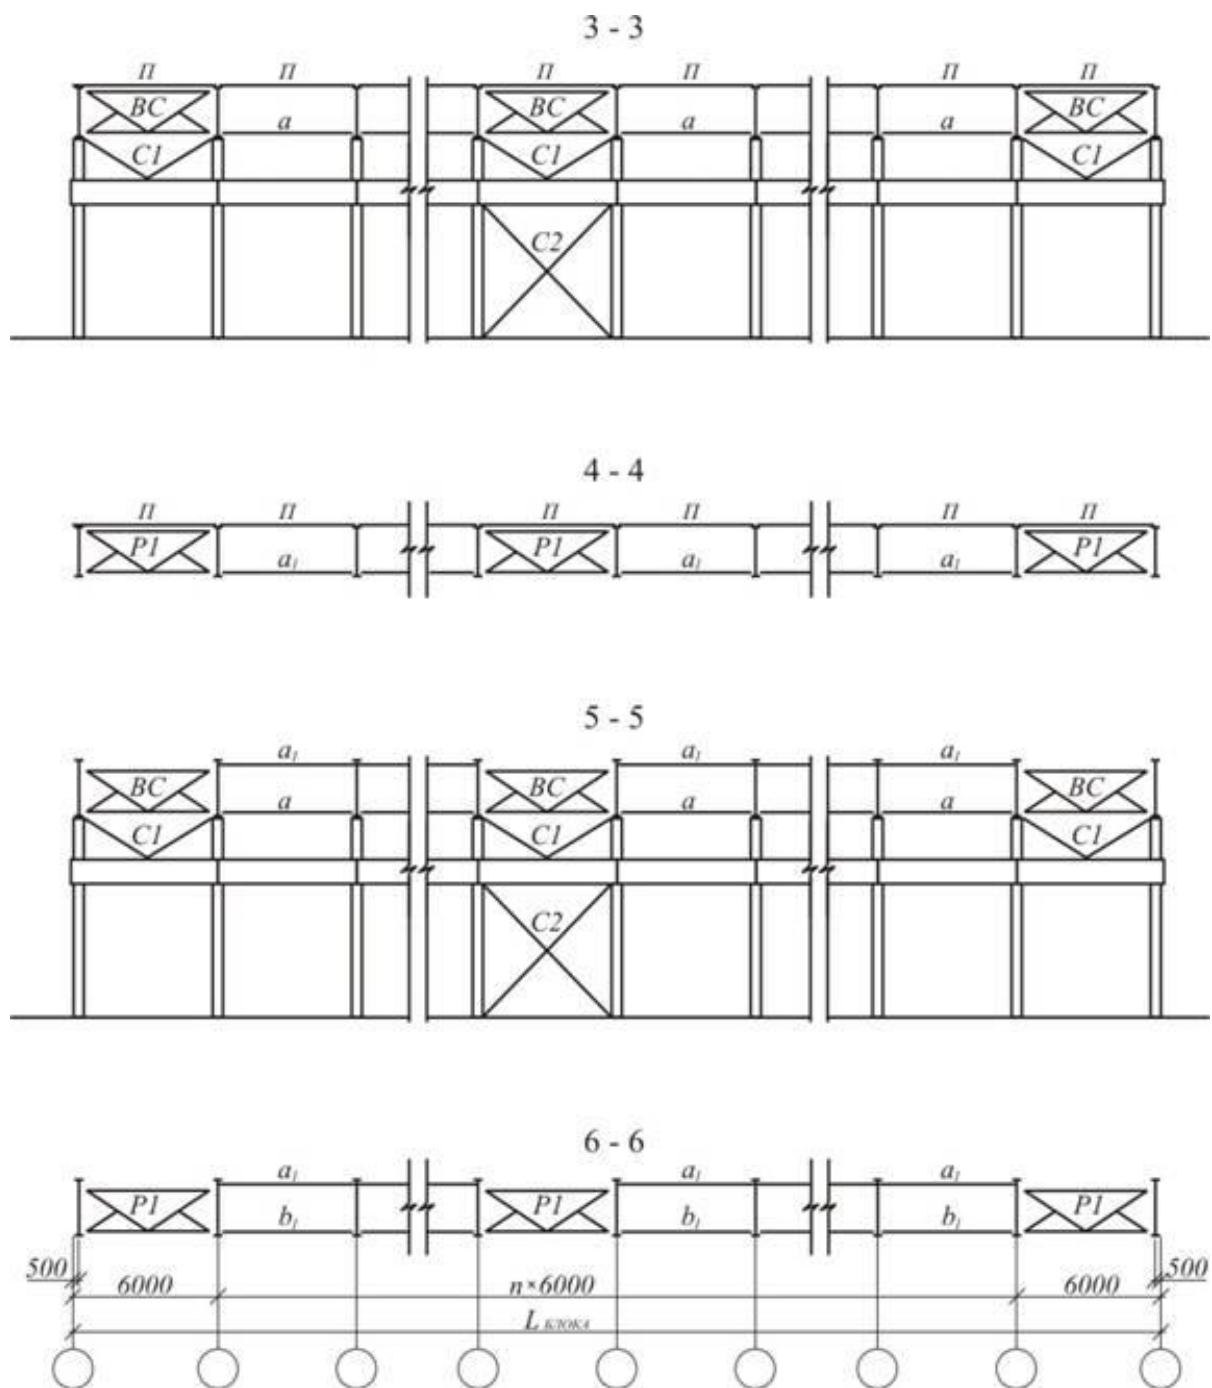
Вертикальні зв'язки по колонах і фермах,
